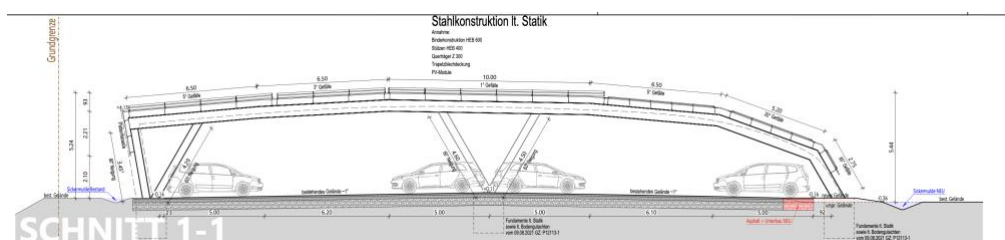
Seitenansicht Stahlkonstruktion inkl. Trapezblech
